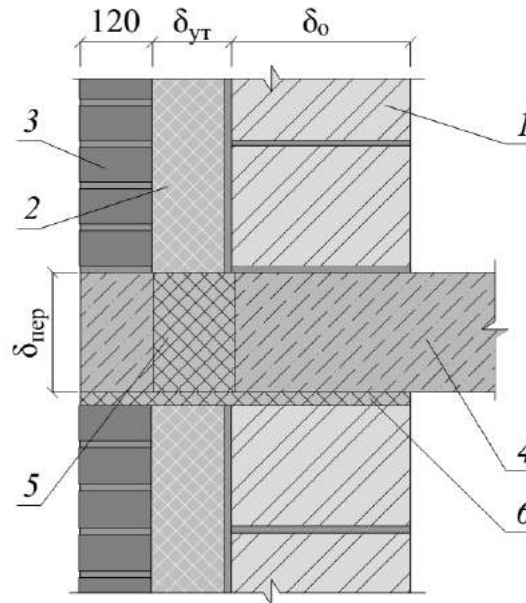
Схема узла сопряжения трехслойной стены с плитой перекрытия: 1 – основание (кирпичная кладка); 2 – тепловая изоляция; 3 – облицовочный кирпич; 4 – плита перекрытия; 5 – перфорация (5/1); 6 – прокладка
